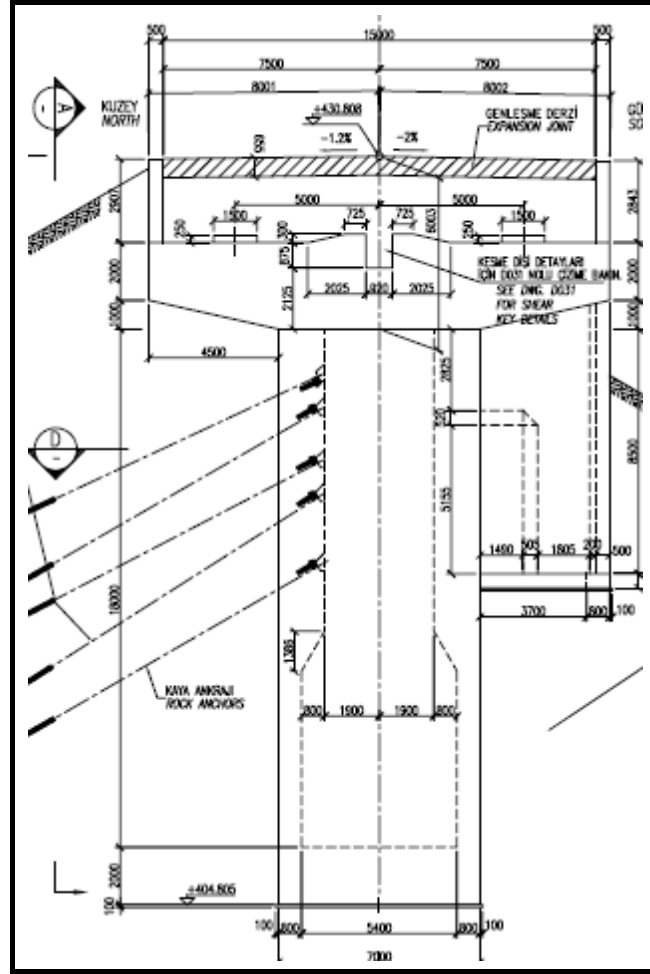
P2 temeli plan ve kesitleri, (DSİ, 2007)
